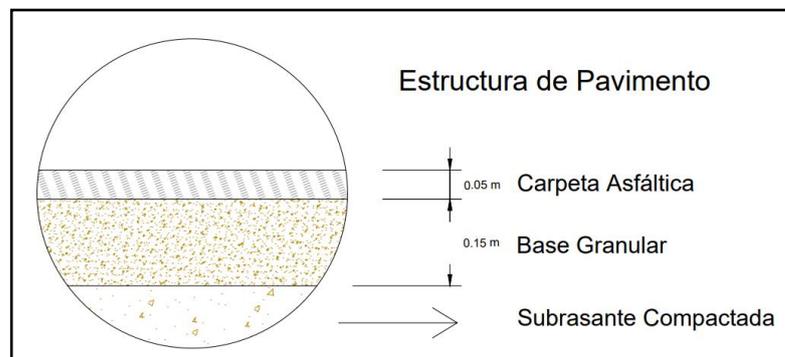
Propuesta de estructura de pavimento para la ciclovía.
